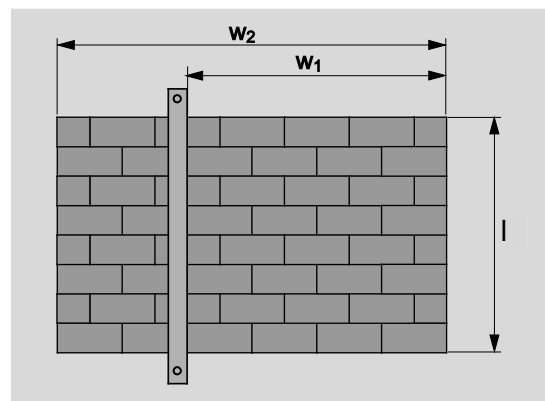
calfeutrement vierge dans les planchers (dalles)
